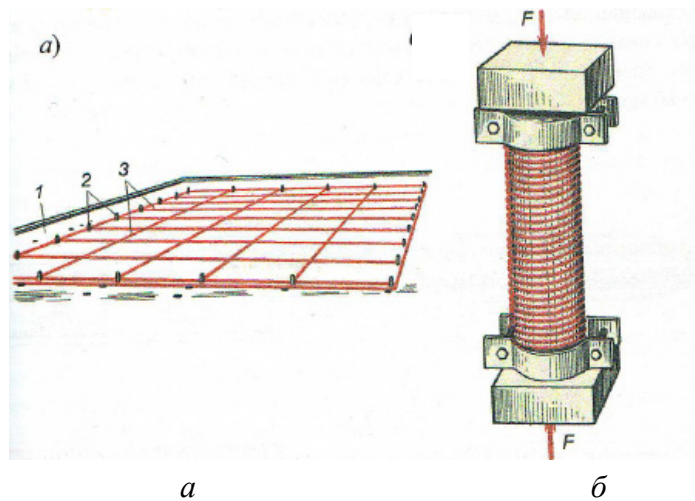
Армирование конструкций высокопрочной проволокой:
